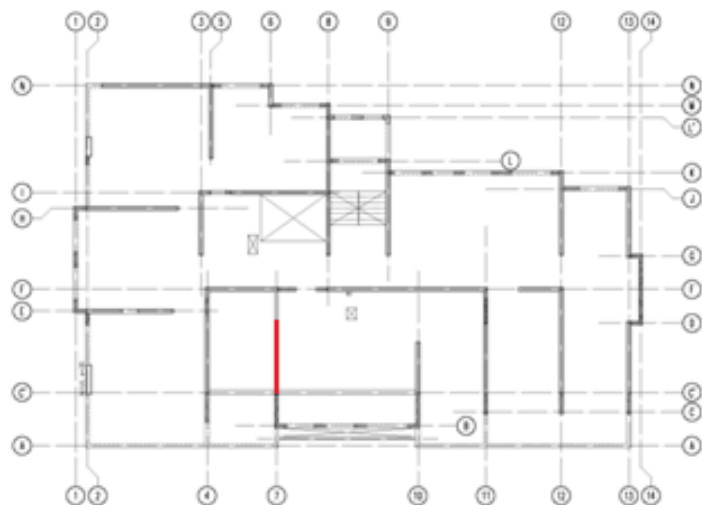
Daños en Muro L Eje 4, Nivel Primer Piso
